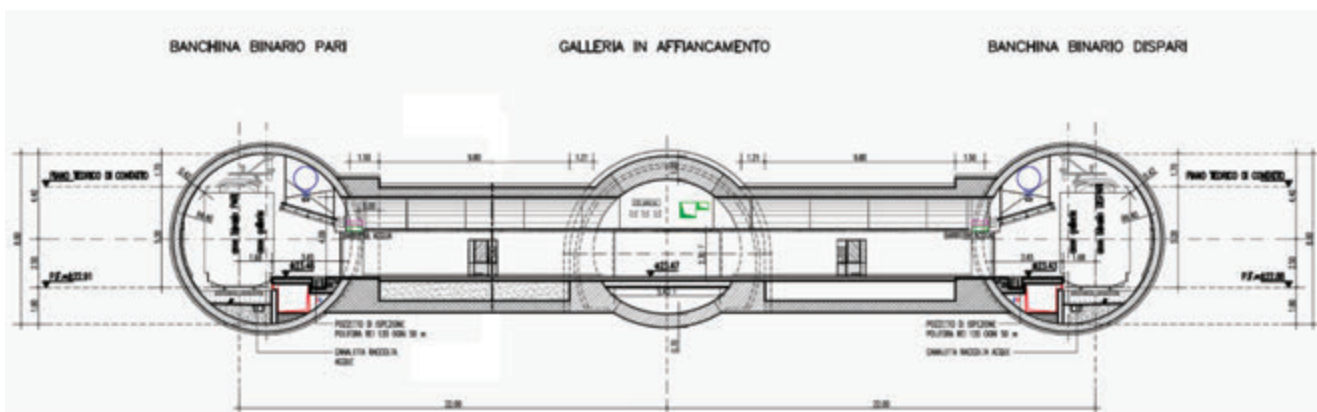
Sezione tipo della fermata sotterranea Bocchetta - Piano binari.
